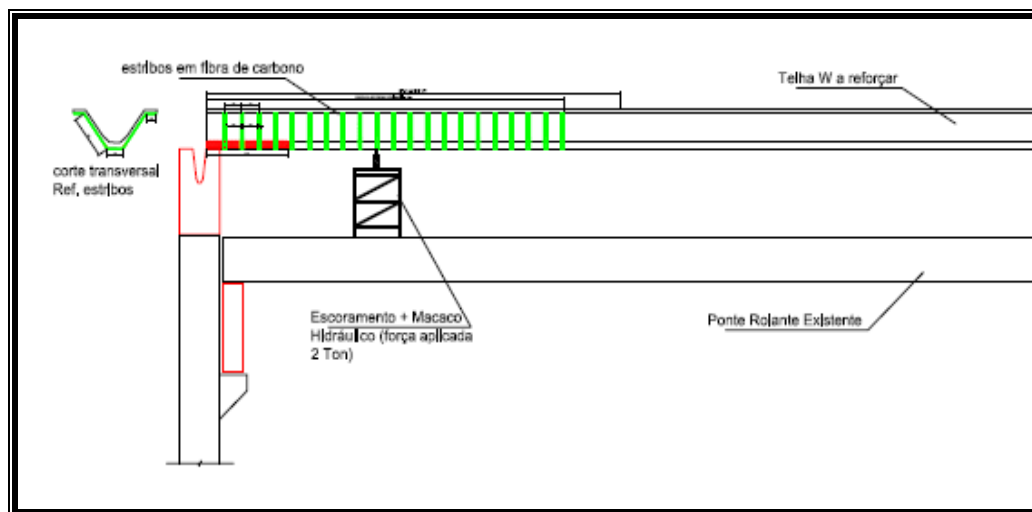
detalhe do reforço estrutural com manta de fibra de carbono telhas calha em concreto protendido.
